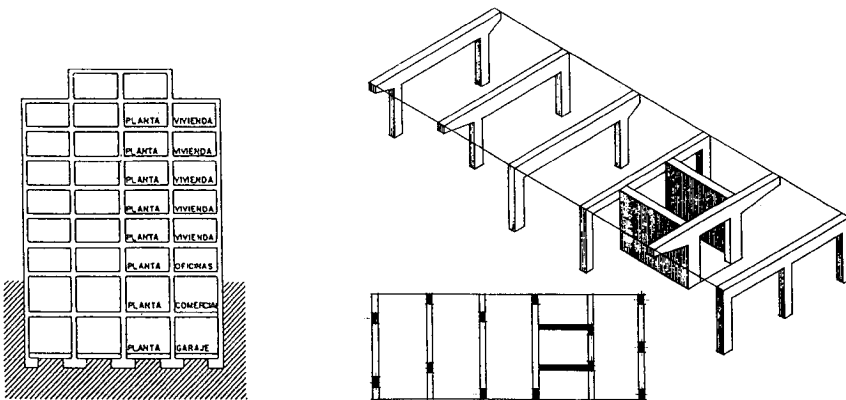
Estructura tipo 3. Distribución uniforme de masas en planta agrupando usos por planta
